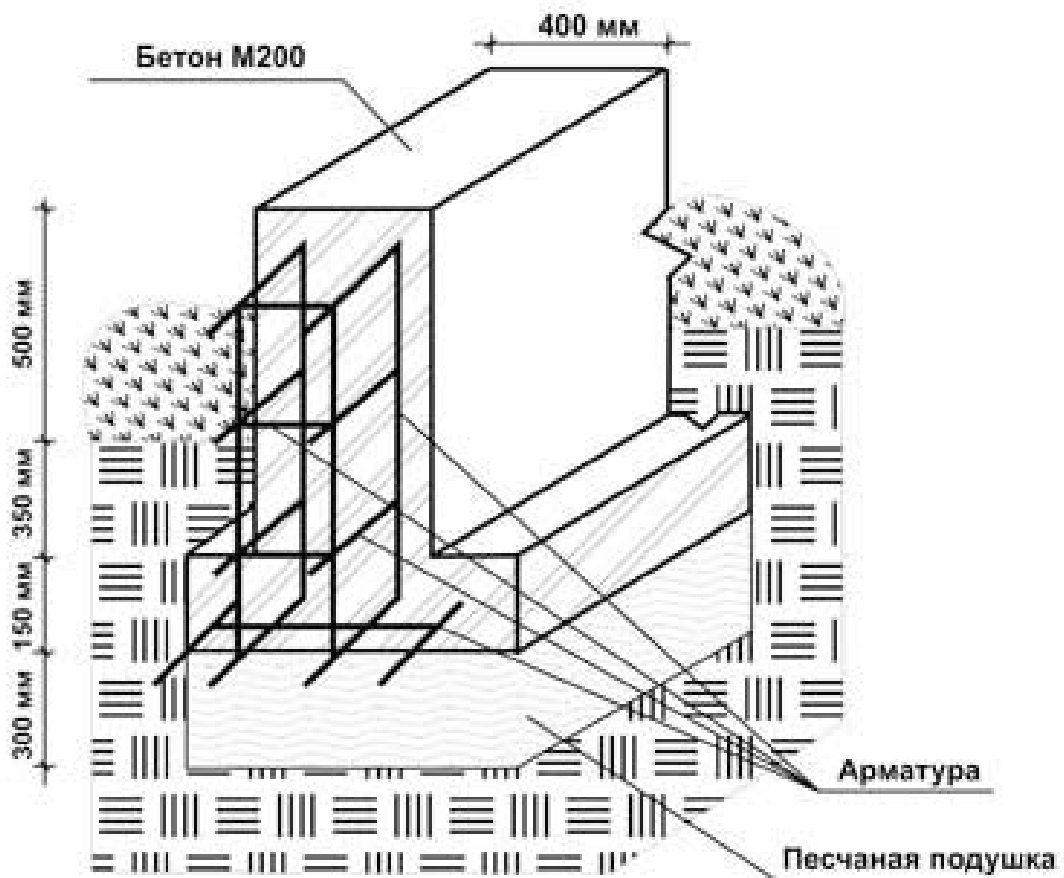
Схема монолітного фундаменту зі залізобетону
